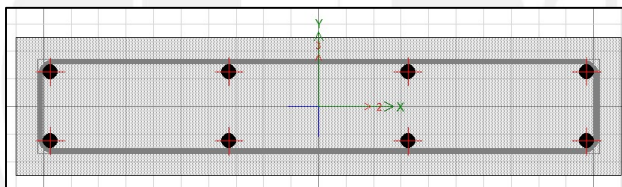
Vista en planta columna C04 (Eje C-2)
